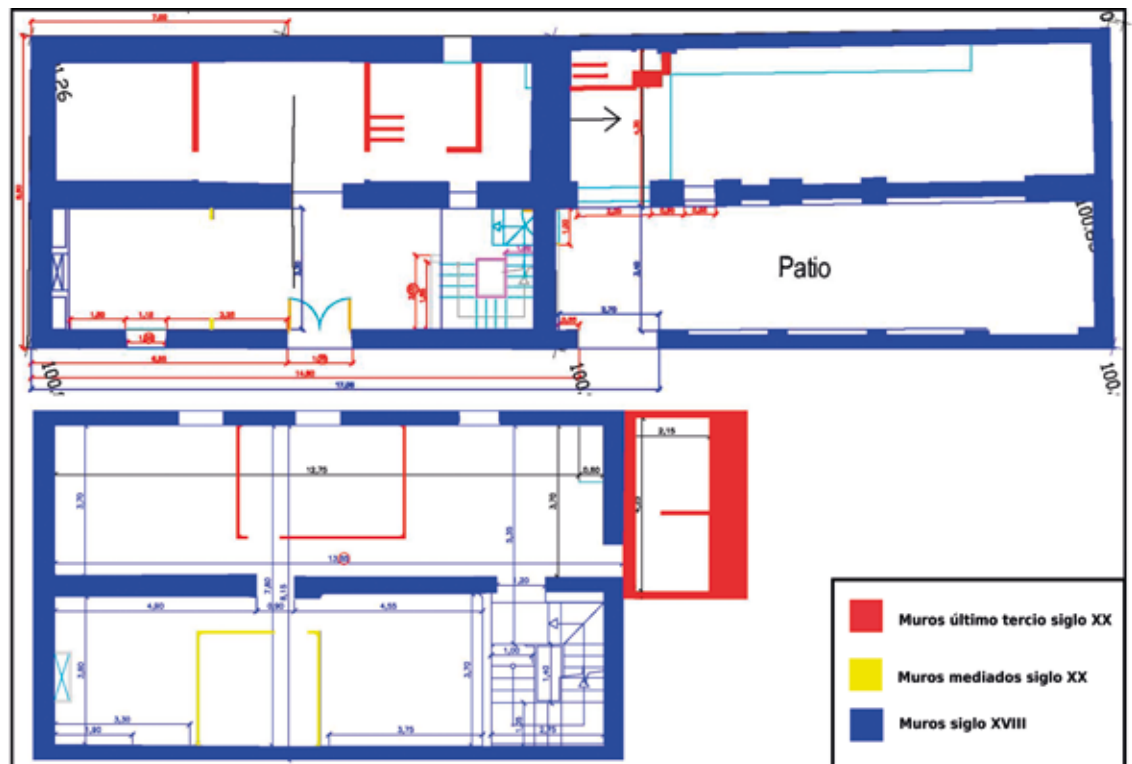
Planimetría donde se reflejan en varios colores las diferentes fases constructivas del inmueble. Planta baja en la parte superior y planta primera en la inferior.
